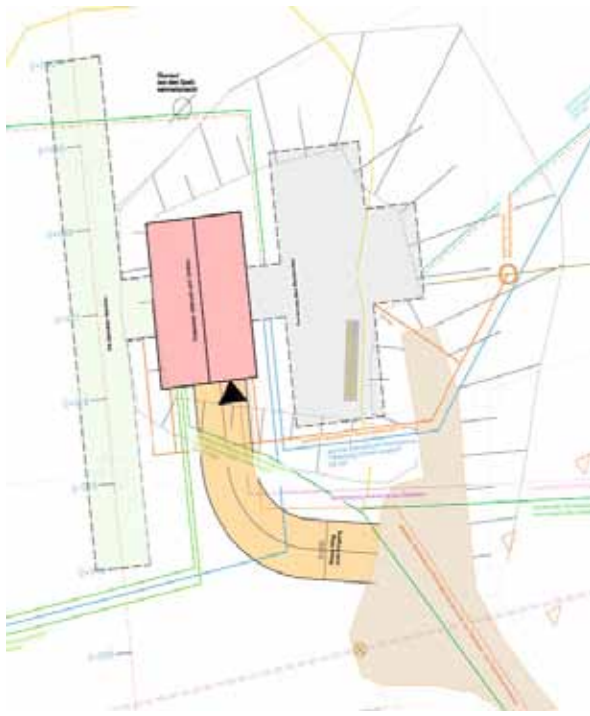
Lageplan Trinkwasserspeicher in Langdorf.
